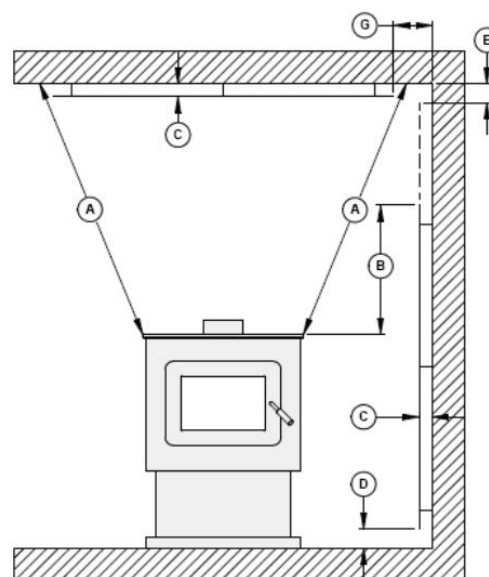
Dégagements pour l'écran de chaleur mural et de plafond
